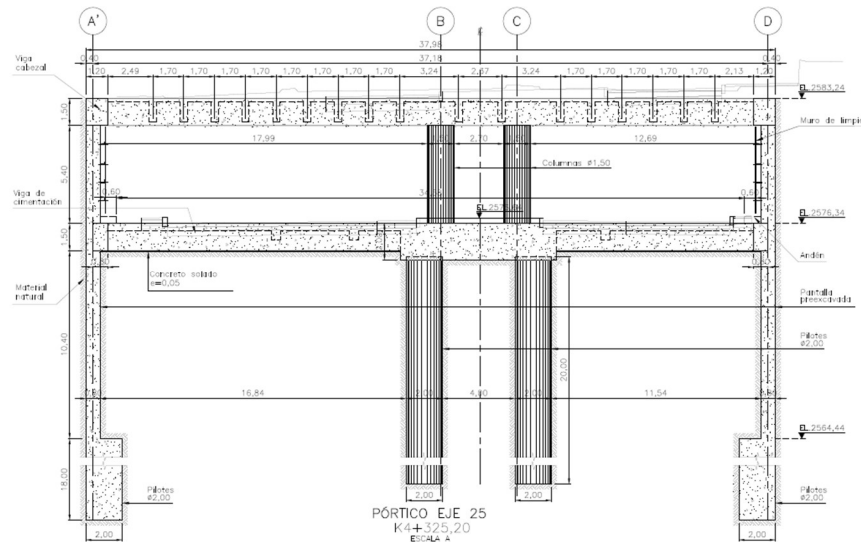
Perfil sector rotonda intersección Cra 7 con Calle 72 - Corredor verde - Fuente: Ingetec ( 2017)
